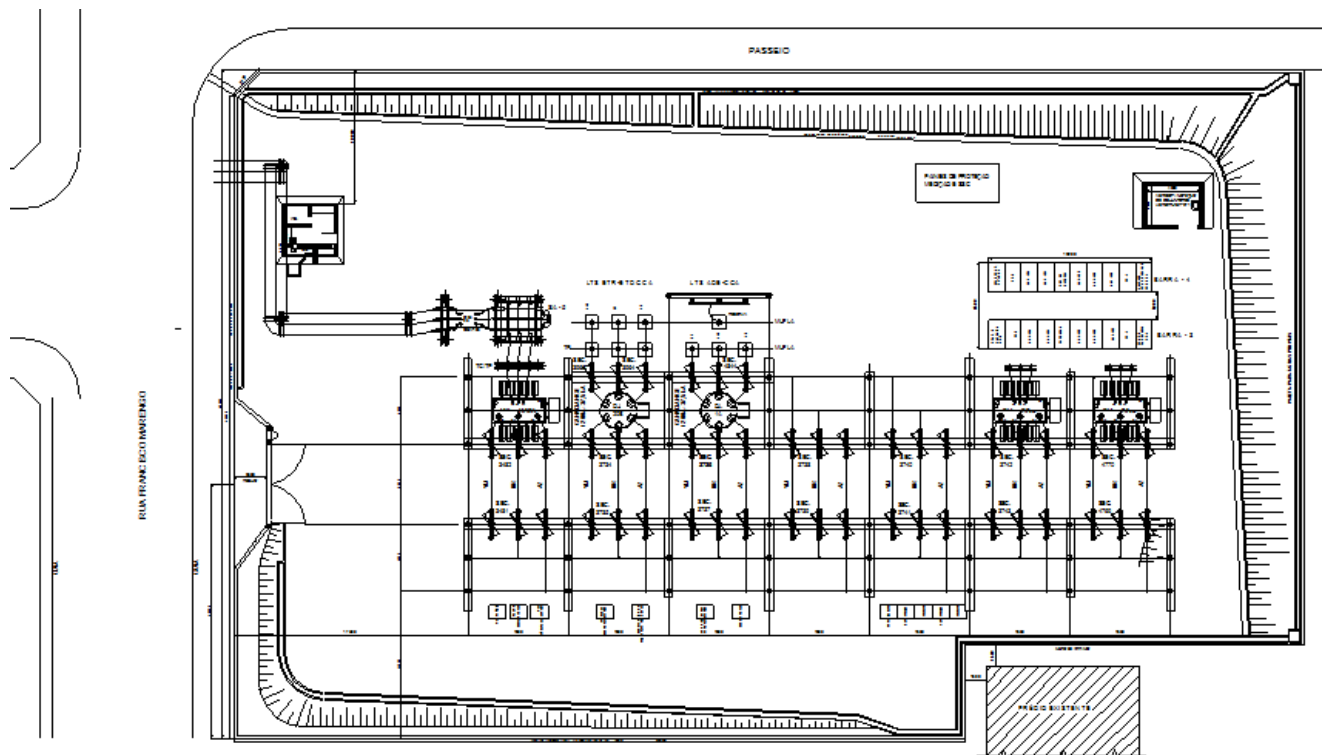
Planta da subestação ETD Gomes Cardim – Situação atual
